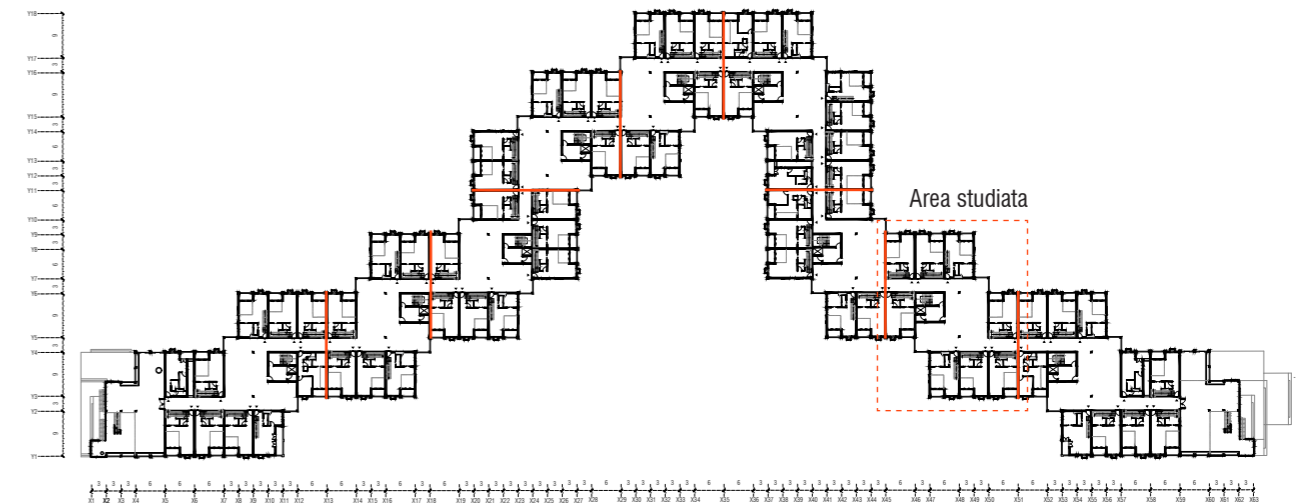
Pianta del piano 1A con la posizione dei giunti di dilatazione
